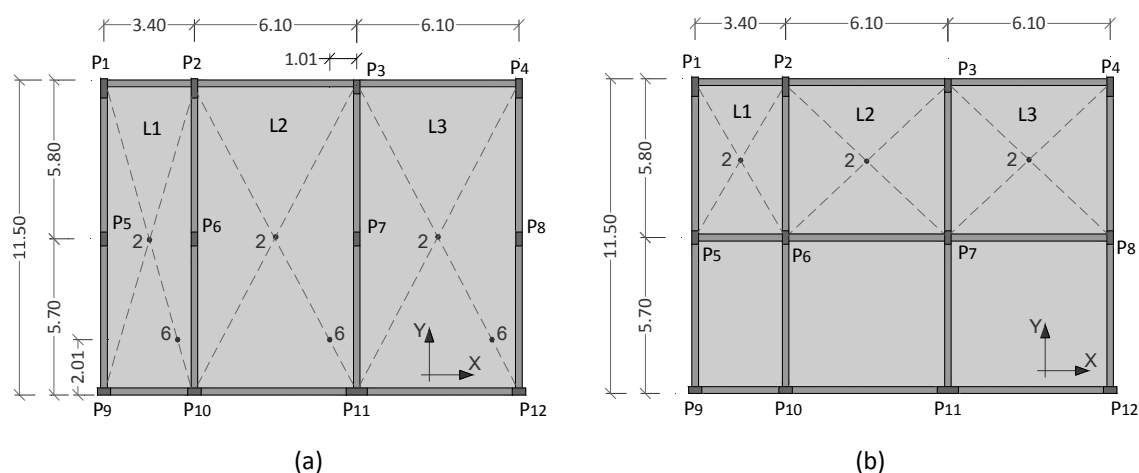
Plantas estruturais dos modelos ditos parciais: (a) estrutura parcial tipo “A” (b) estrutura parcial tipo “B”
